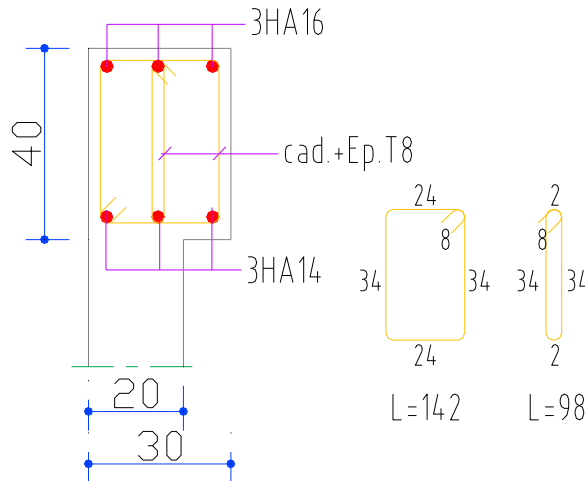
Ferrailage des poutres principales au niveau de travée.
